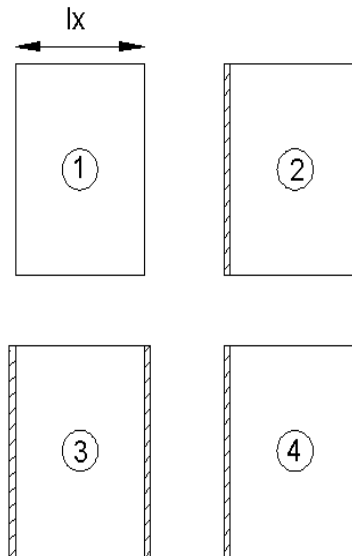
Condições de apoio para lajes armadas em uma direção (ARAÚJO, 2003).
